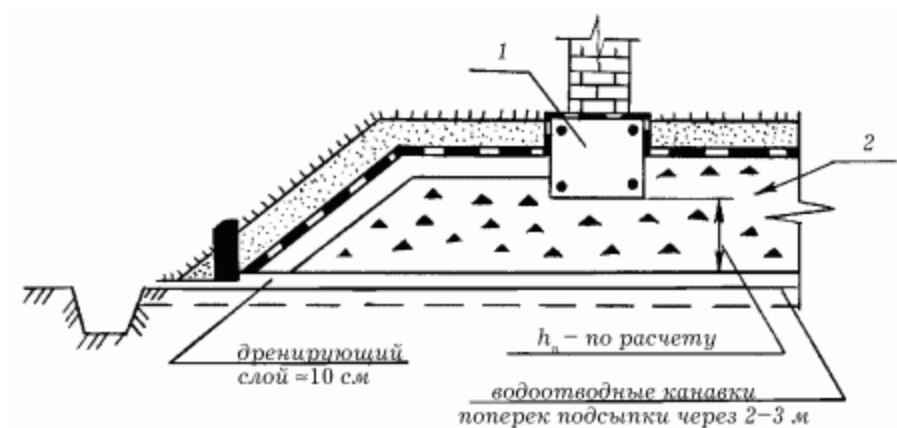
Устройство малозаглубленного фундамента на теплоизоляционной подушке: 1 – малозаглубленный фундамент; 2 – теплоизоляционная подушка.
